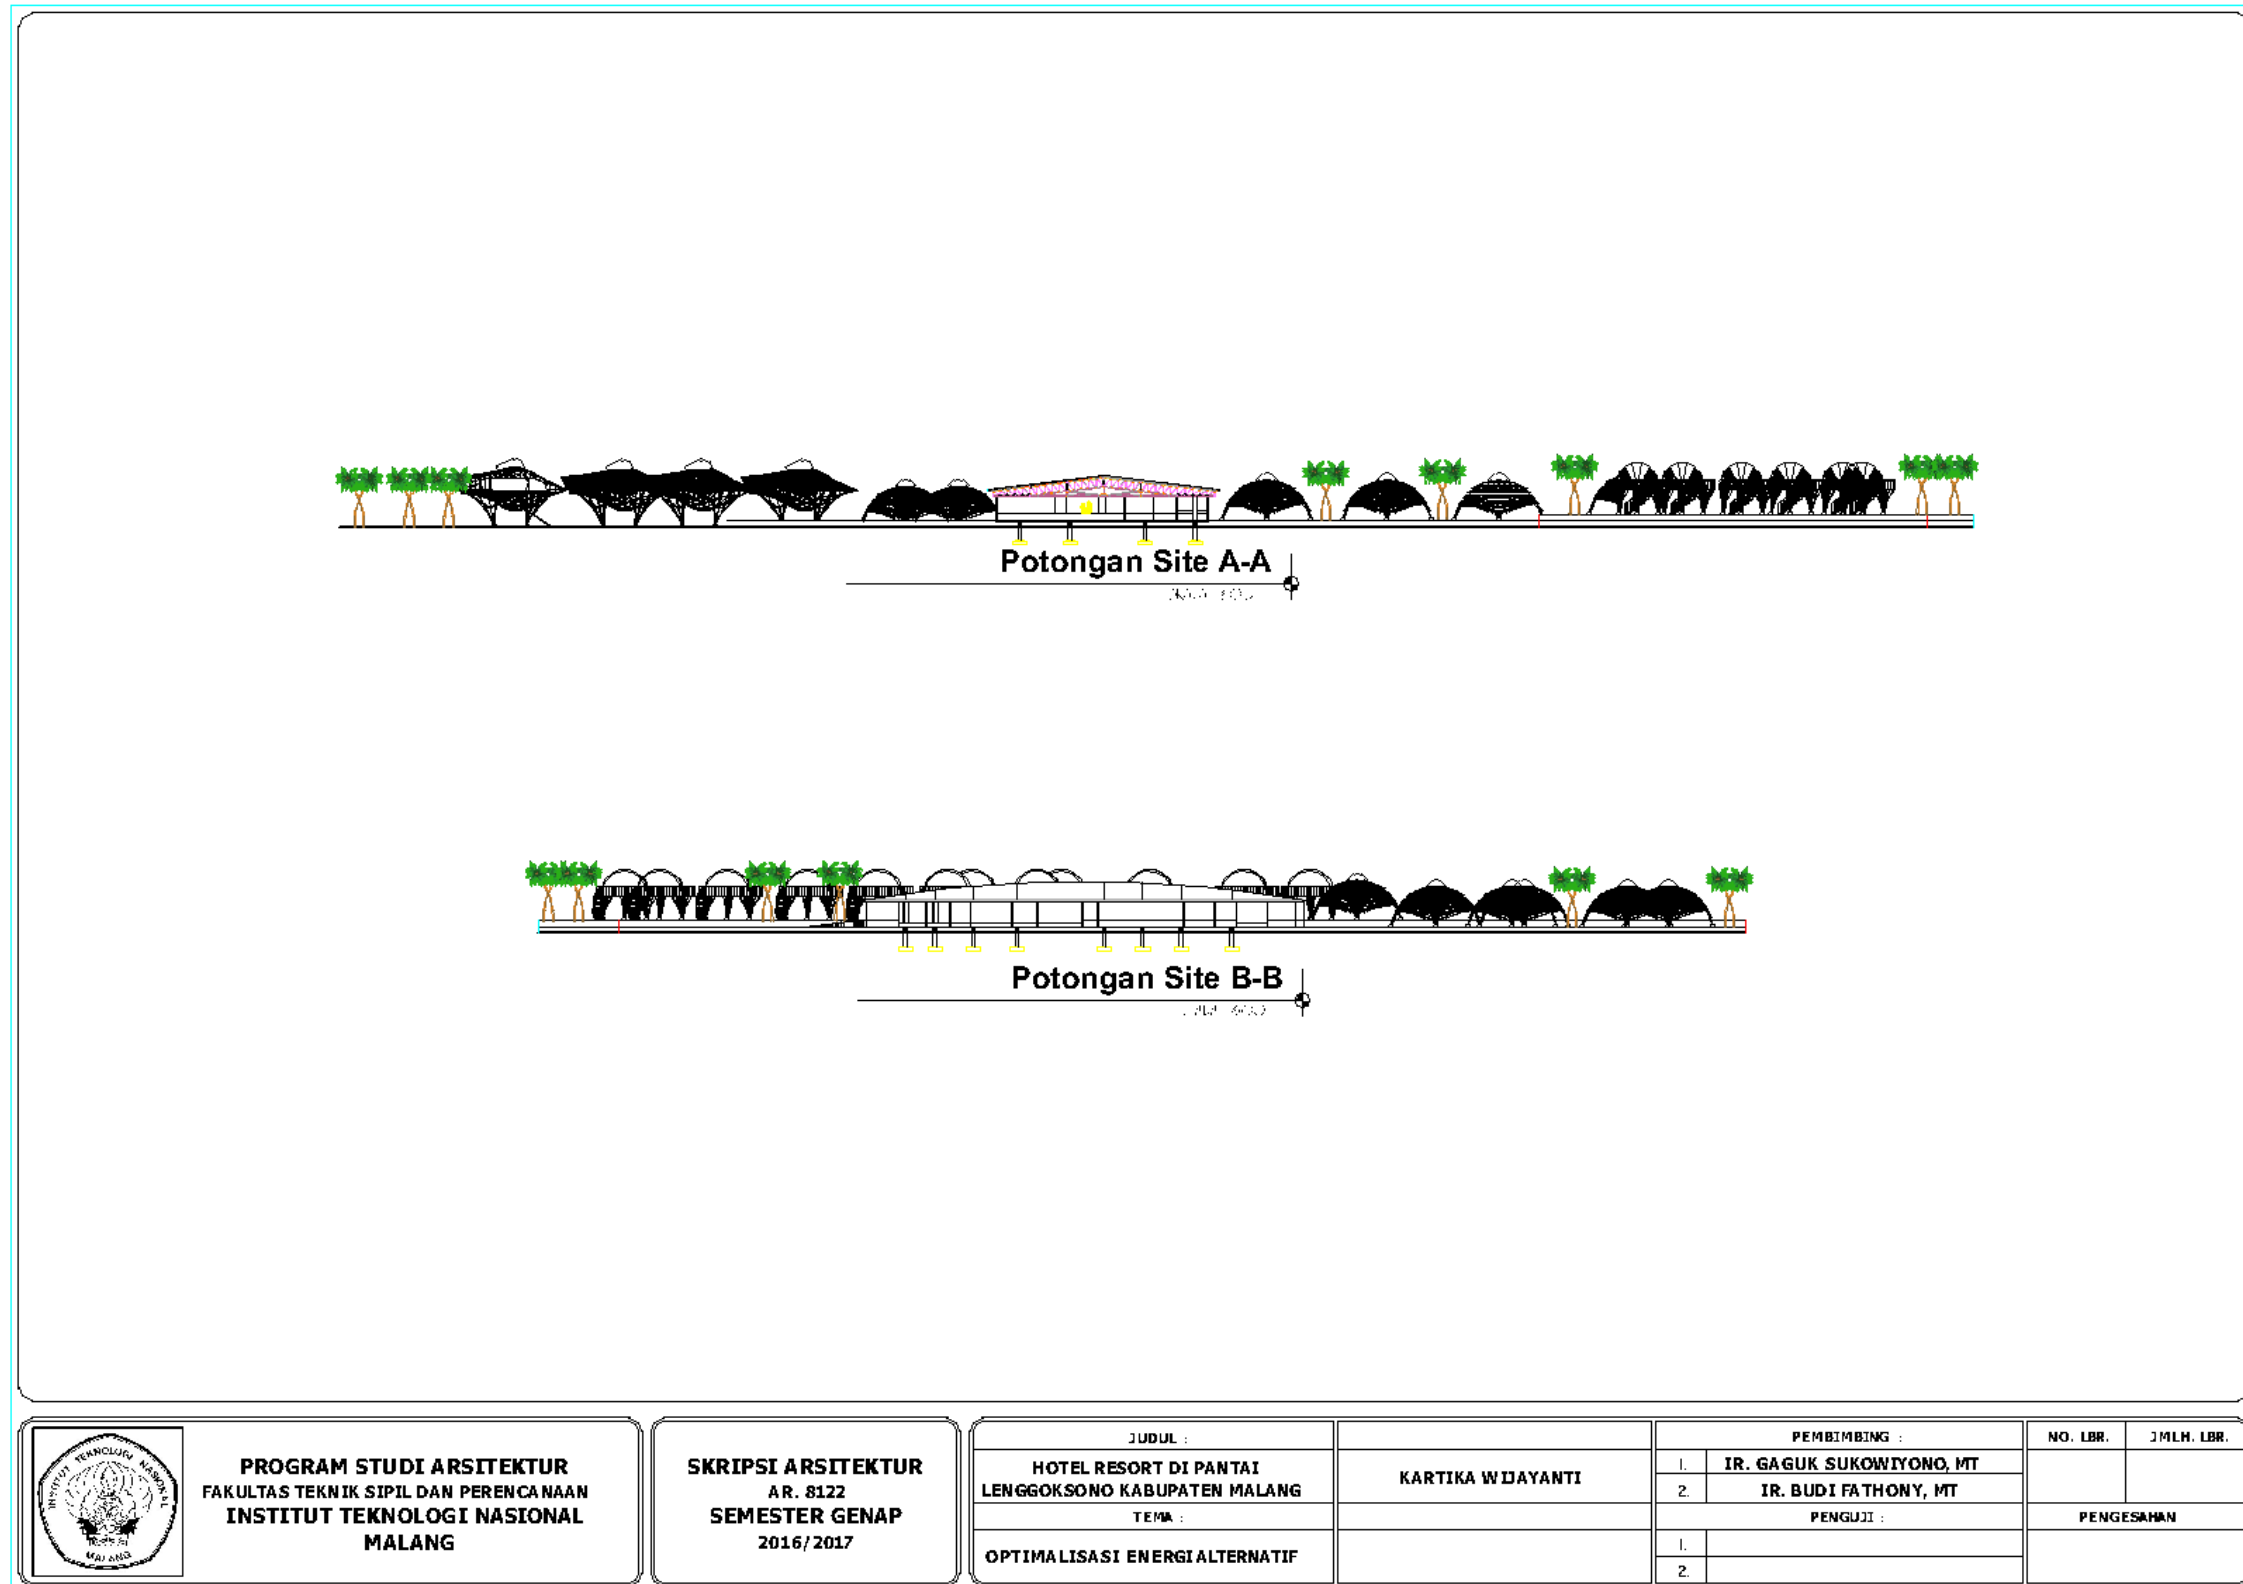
Gambar Key Plan Tampak Site (Sumber: DokumenPribadi)
